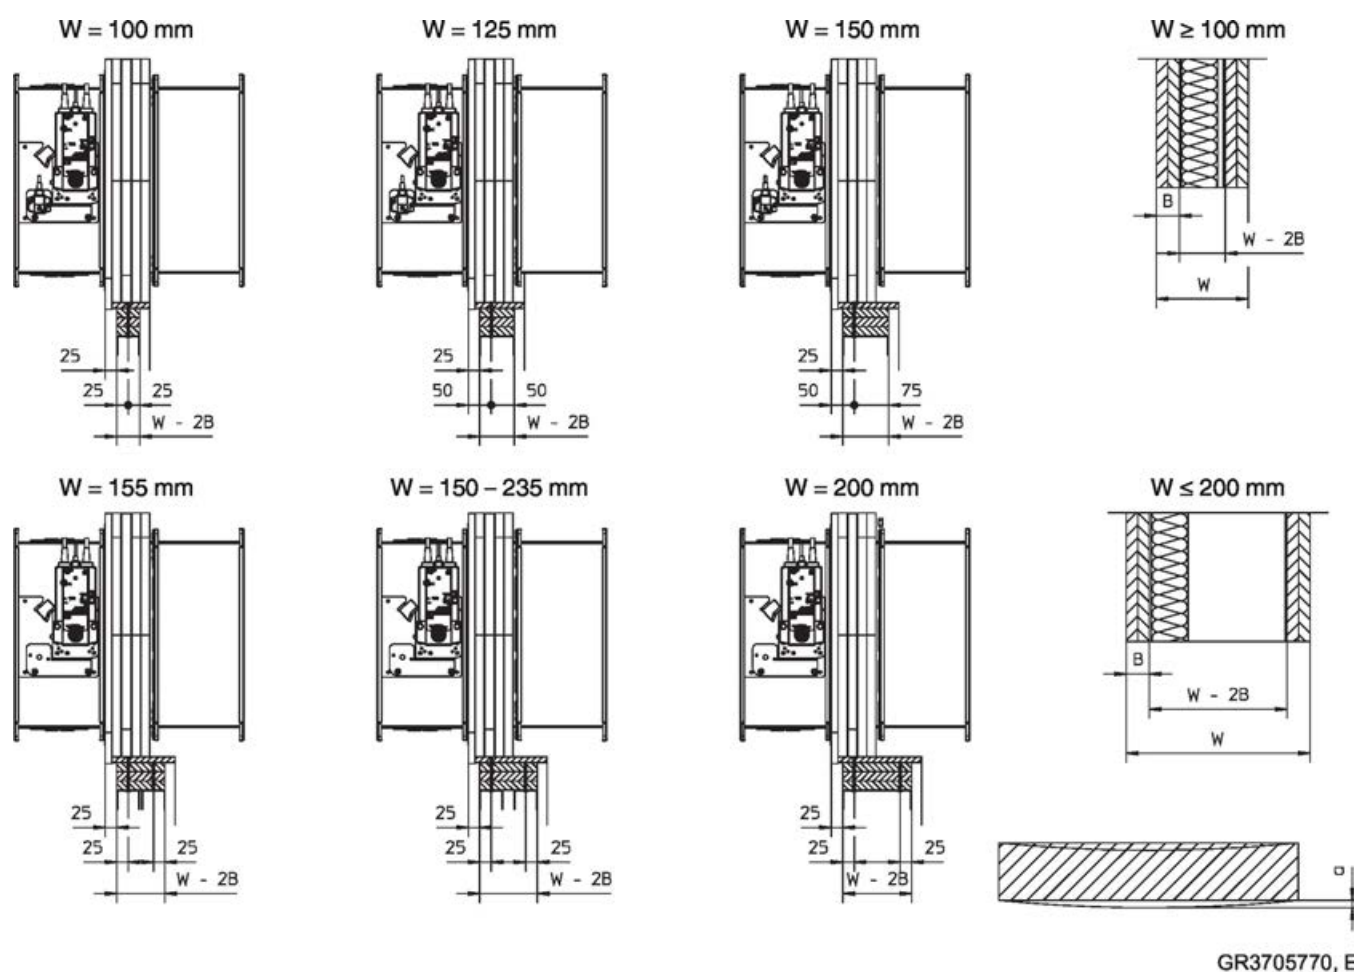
Installazione senza muratura in una parete divisoria leggera, con collegamento flessibile al soffitto e kit d'installazione GL... – spessori parete
